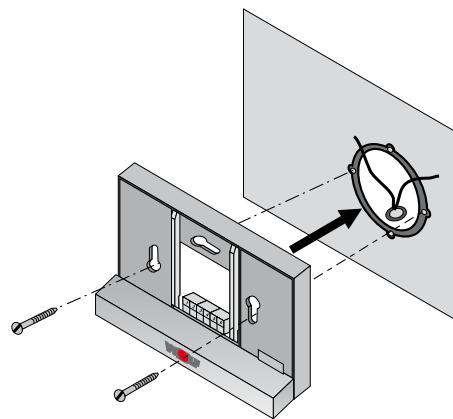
Monter le socle mural BM-2 sur boîte à encastrer (montage sur site)
